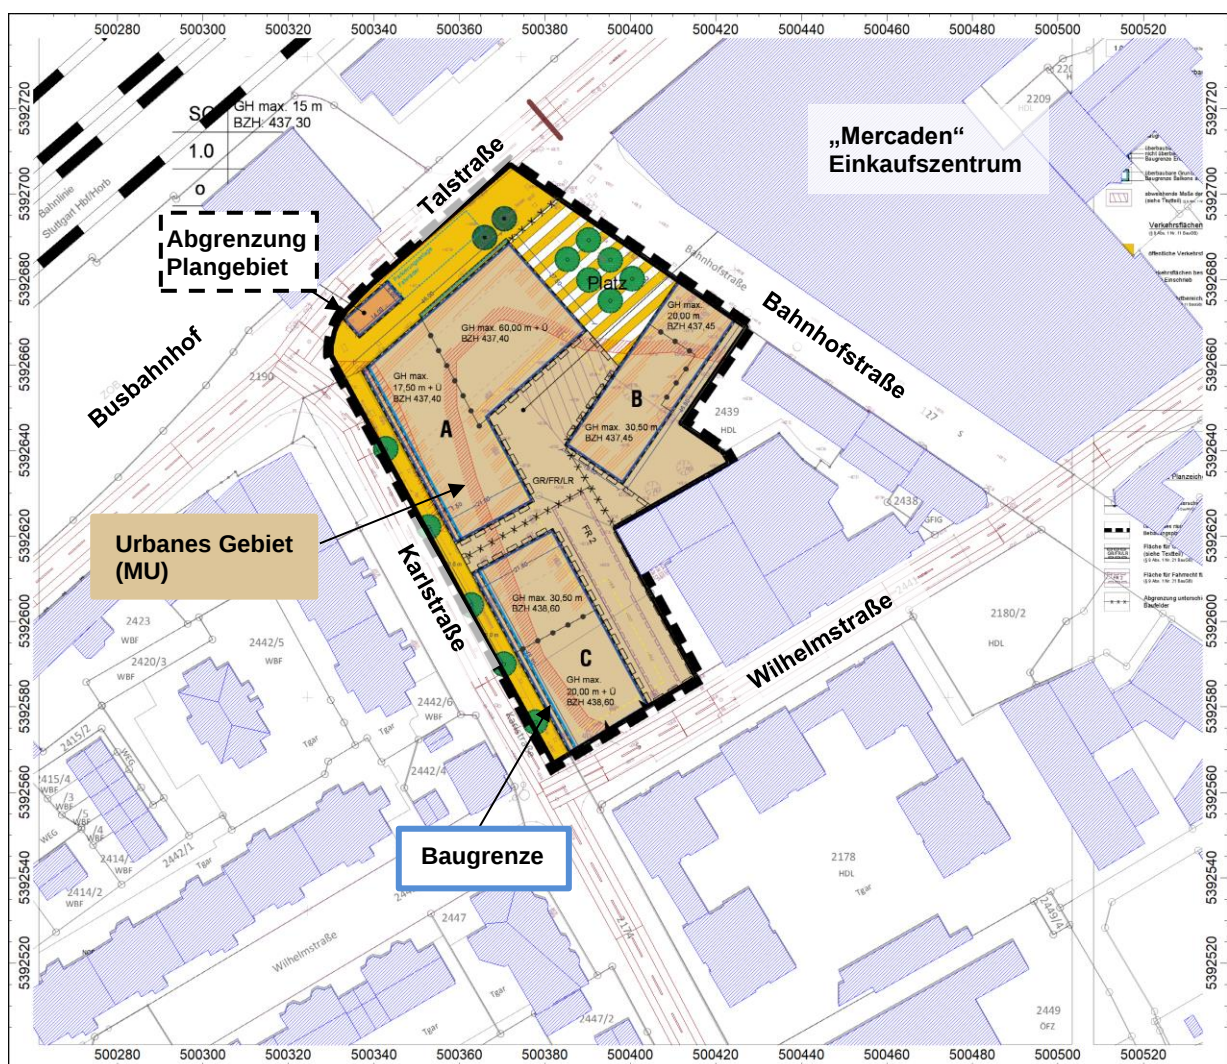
Planzeichnung zum Bebauungsplan „Post-Areal“ gemäß derzeitigem Planungsstand /22/
